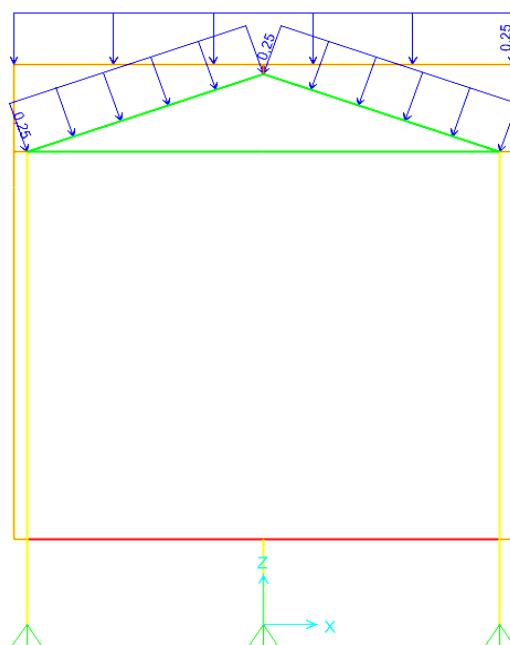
Seção transversal do modelo. Cargas permanentes de fechamento sobre as estruturas superiores do pórtico e caixa estrutural.
